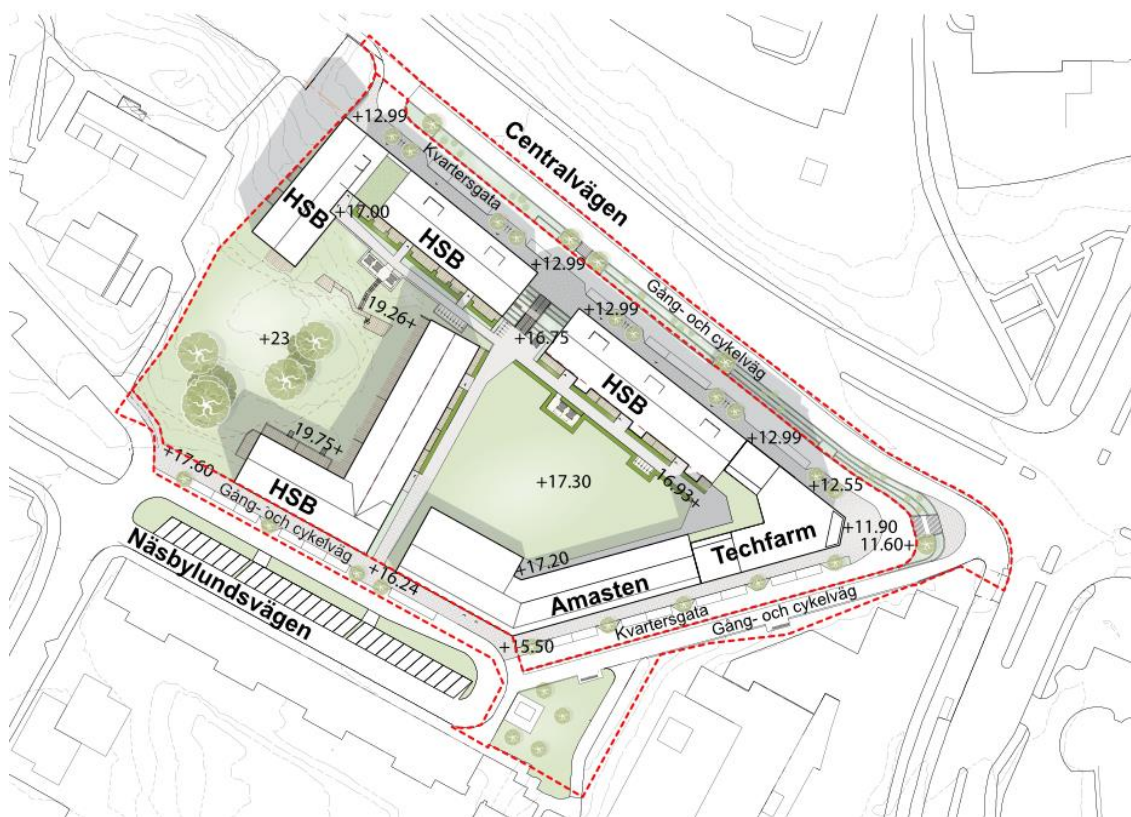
Illustrationsplan som visar planförslaget samt den planerade uppdelningen mellan byggtörer.
